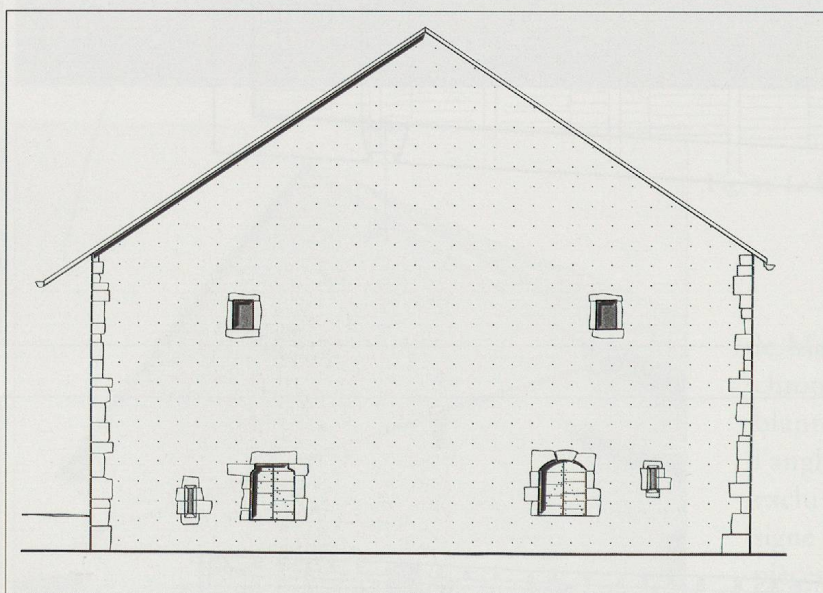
La Conriéry, façade nord-ouest. Échelle 1 : 200
